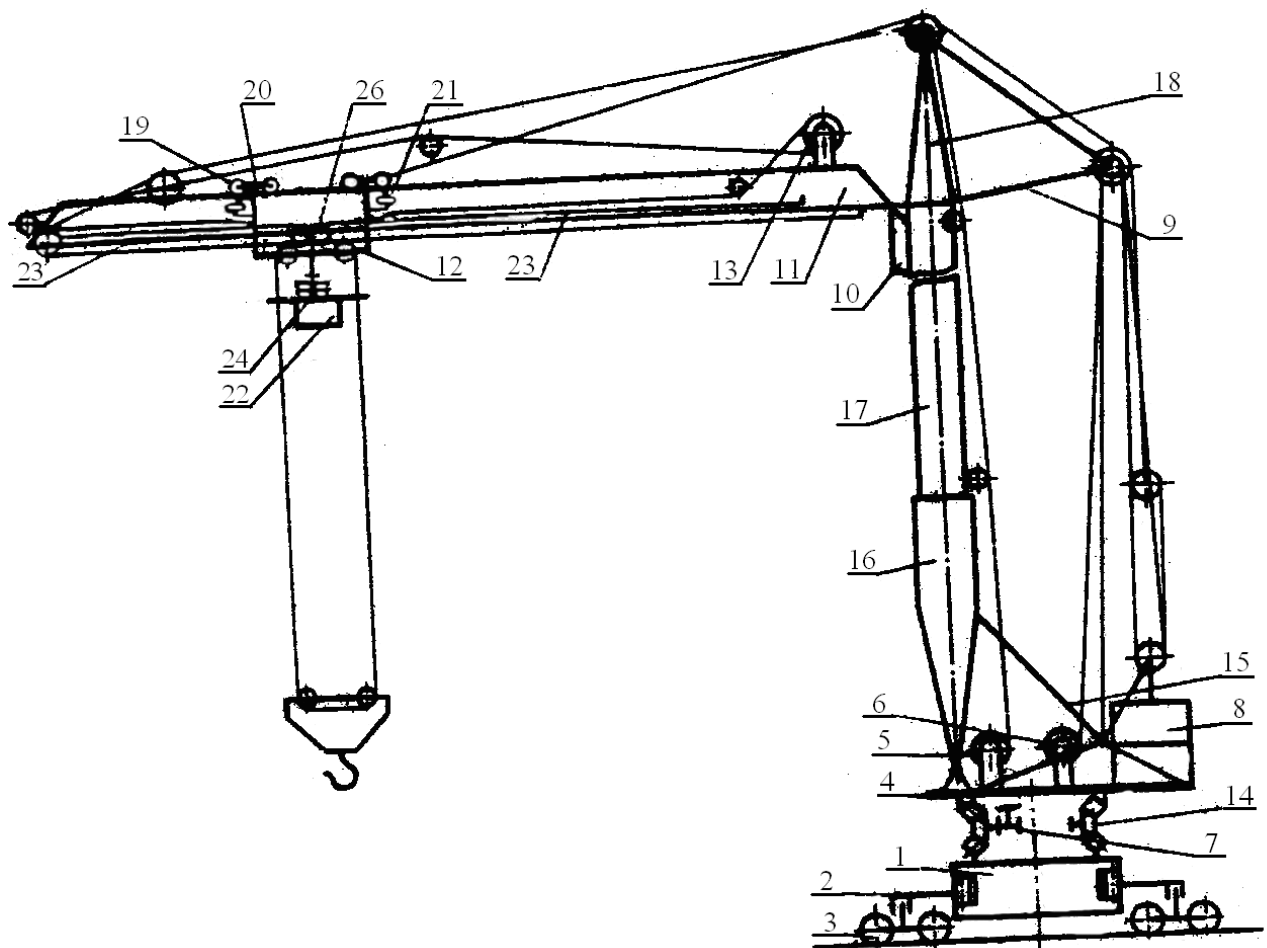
Загальний вигляд крану КБ-403 Б
